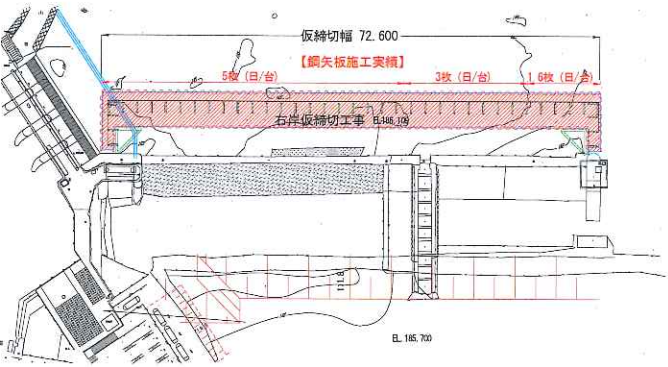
仮締切平面図(右岸側, 鋼矢板二重締切)
